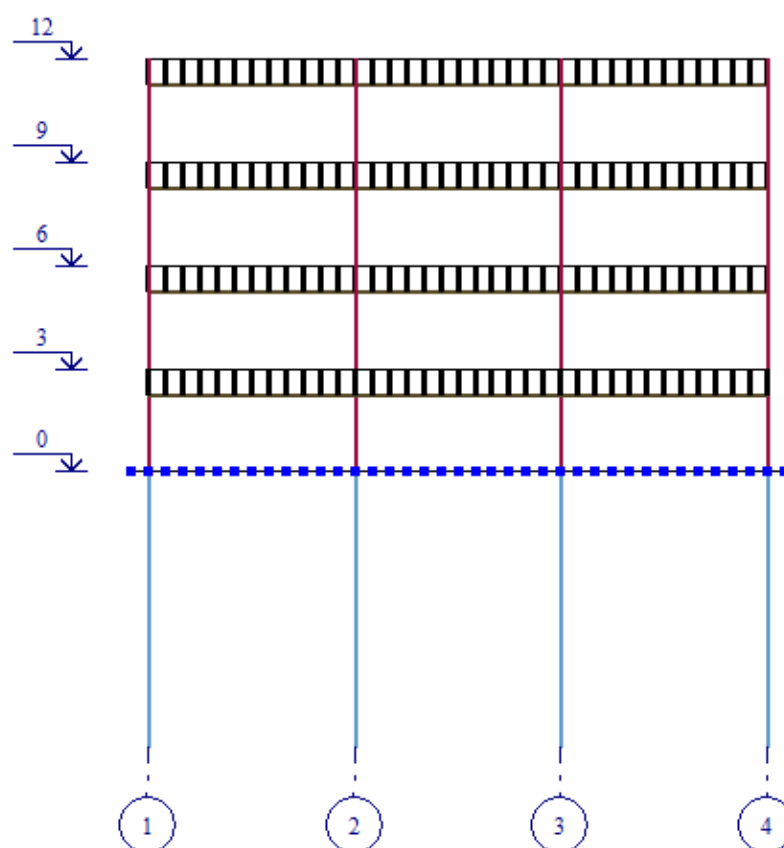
Расчетная схема блока здания в XOZ
